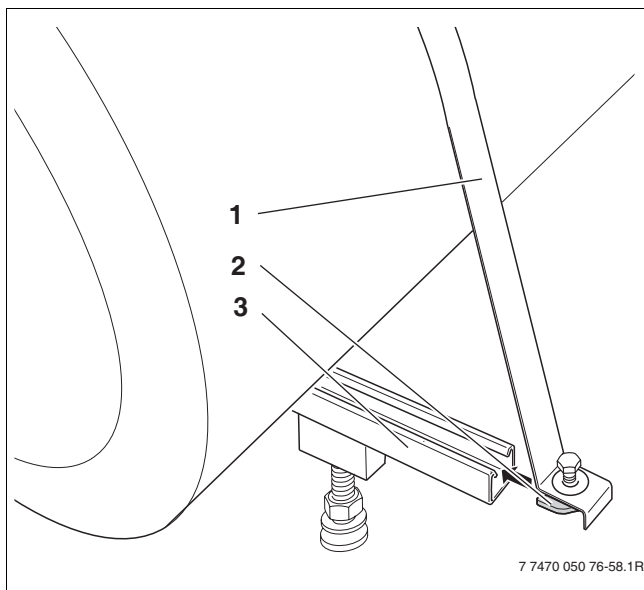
Vista montaje en tejado inclinado (sistema de 300 l)
